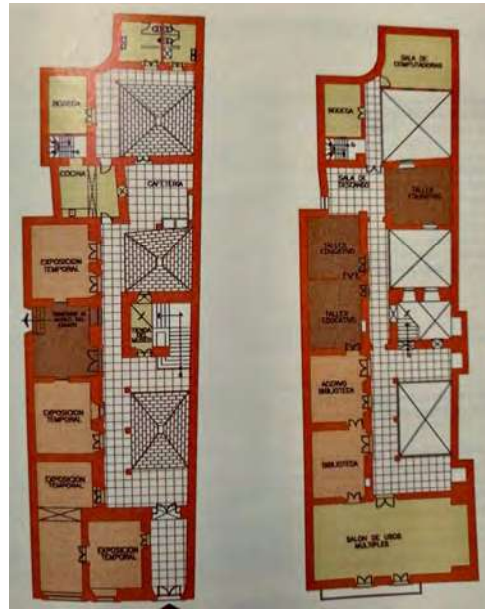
Plantas arquitectónicas después de la primera intervención. En este estado fue encontrado el inmueble.
